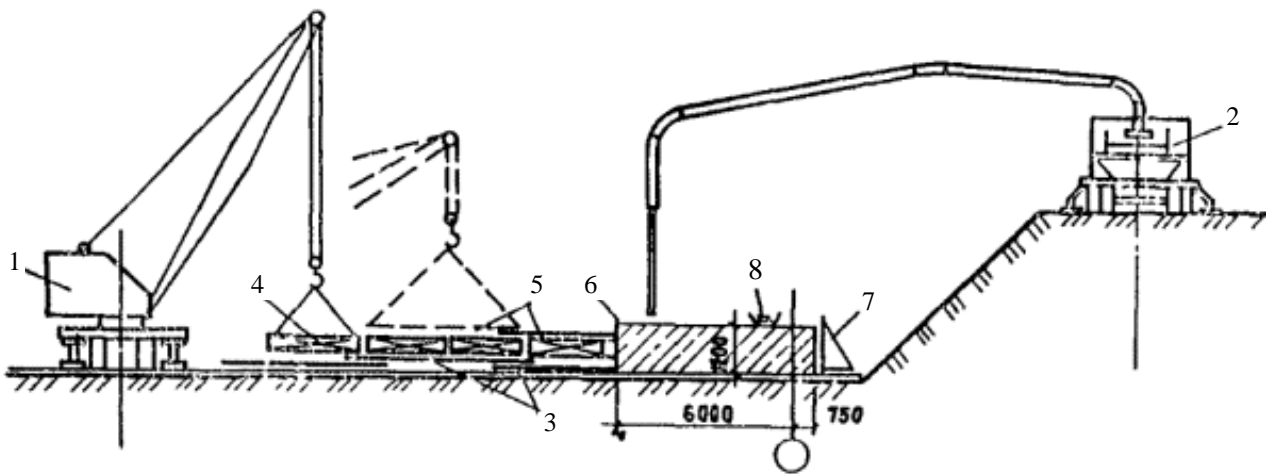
Бетонування фундаментної плити бетононасосом: 1 – автомобільний кран; 2 – автобетононасос; 3 – нижні арматурні сітки; 4 – підтримувальні каркаси; 5 – верхні арматурні сітки; 6 – металева сітка з гніздами; 7 – опалубка щитова; 8 – вібратор поверхневий
